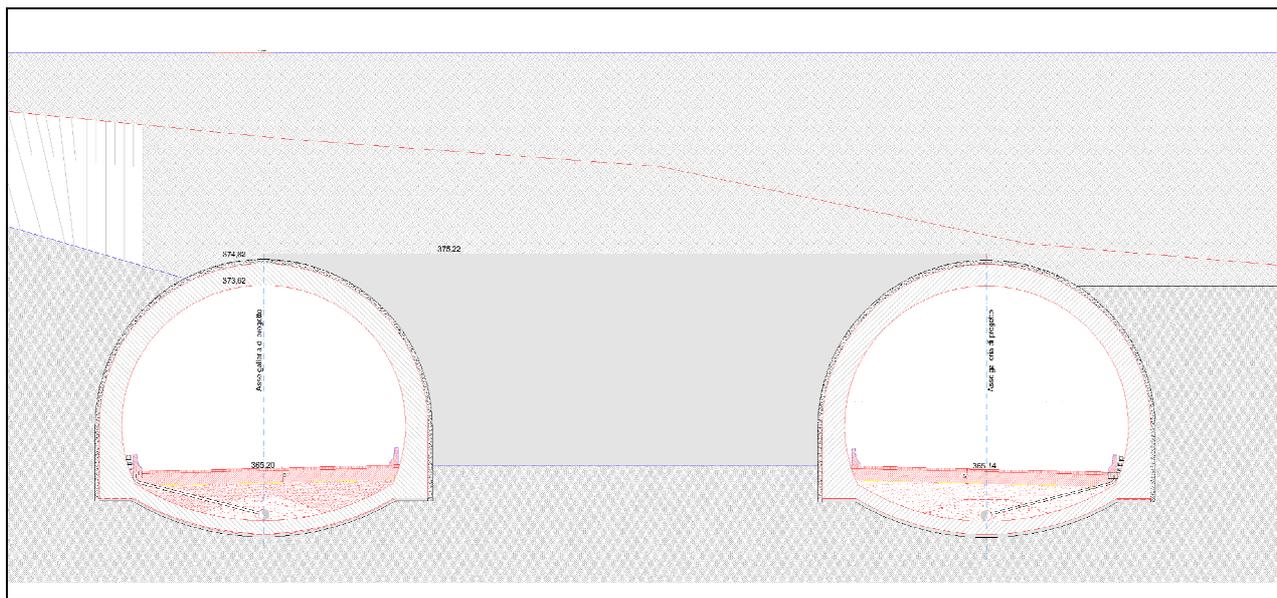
Sezione trasversale area di imbocco –lato Solofra
